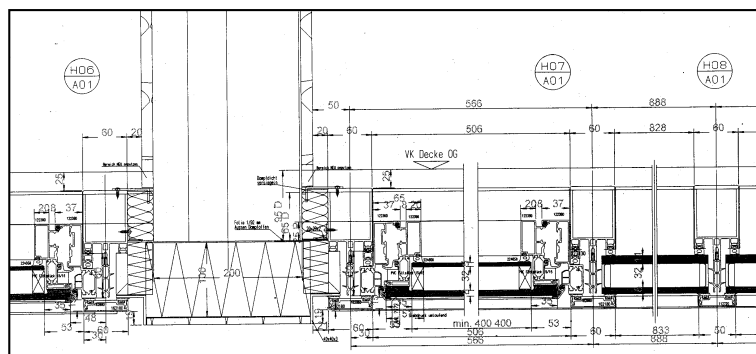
Horizontalschnitt (Stütze und Fassadenanschluss)
